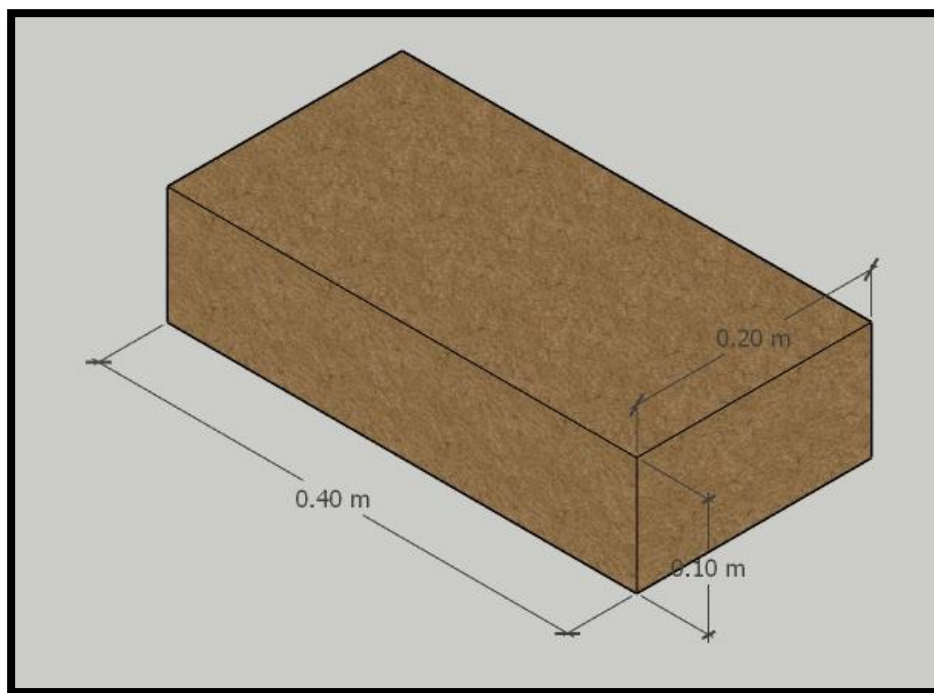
Medidas del adobe utilizado en la construcción de la hacienda Vichaycoto
